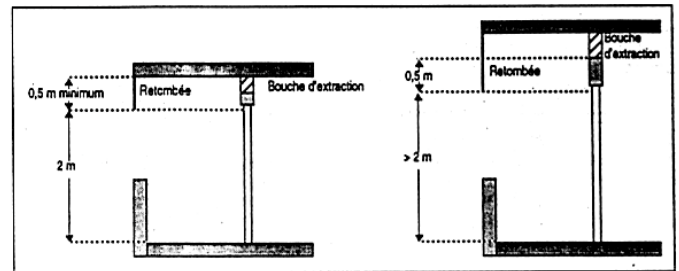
Retombées sous plafond (écrans de cantonnement)
